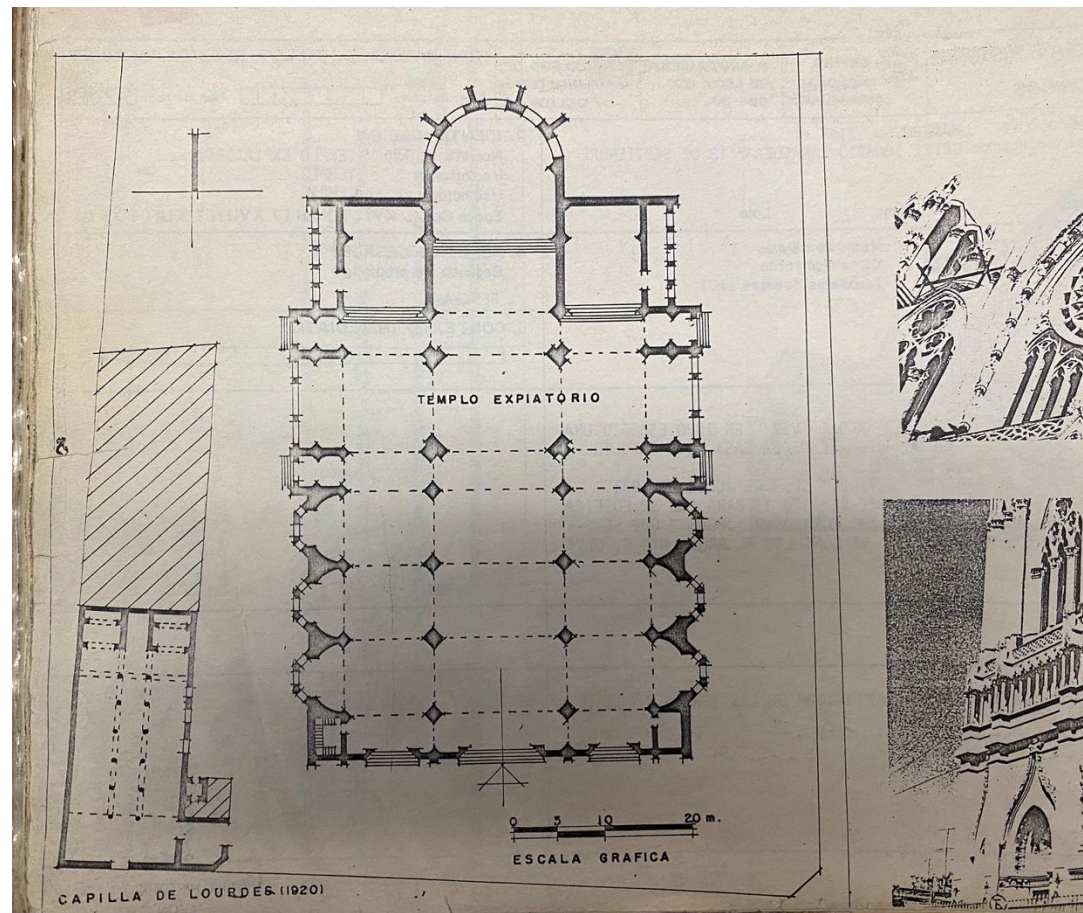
Planta arquitectónica en AHML. (Martínez, 2022)
